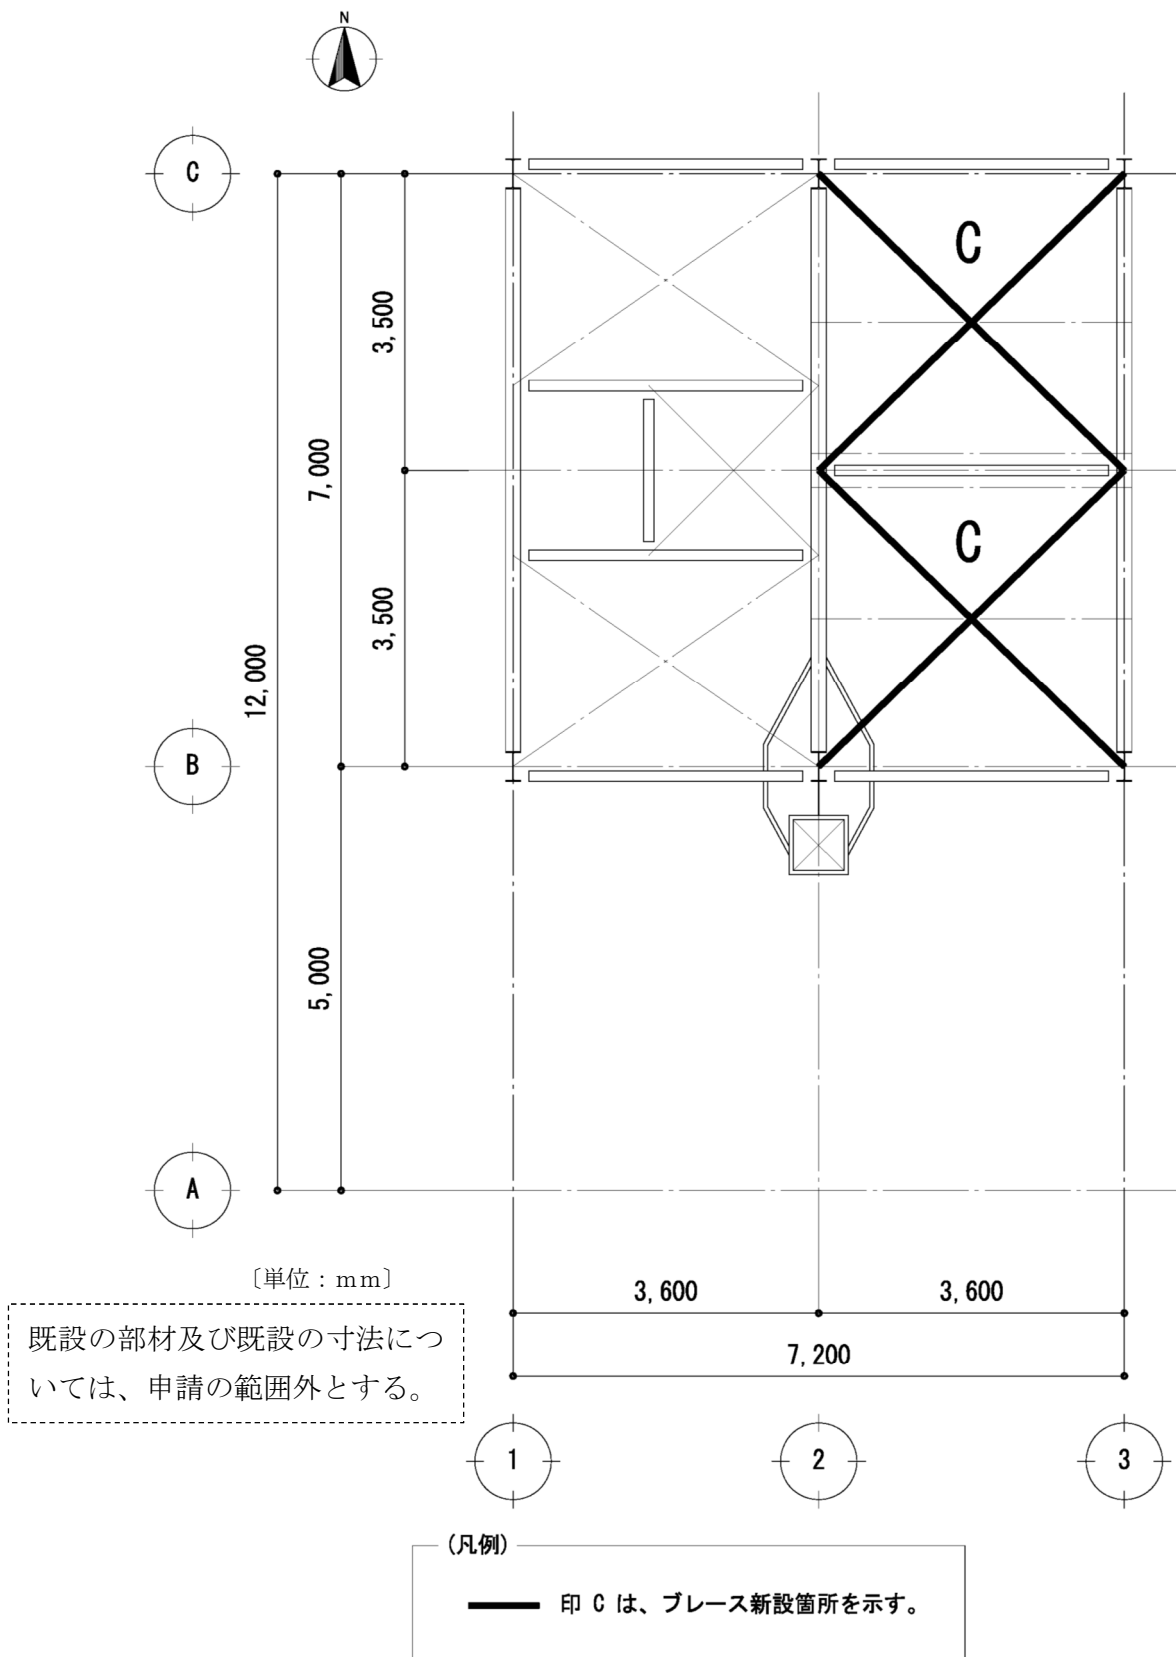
燃料棟 屋根伏図 (R3 レベル)
